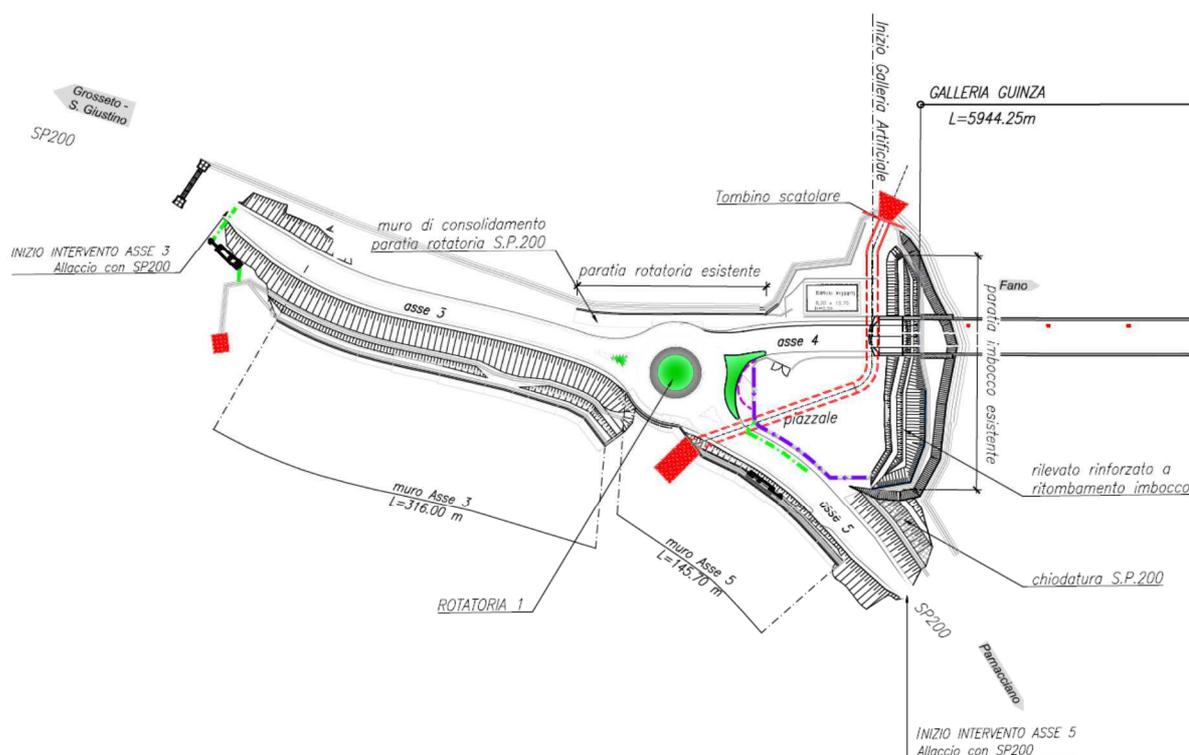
Opere geotecniche presso il collegamento lato Umbria
